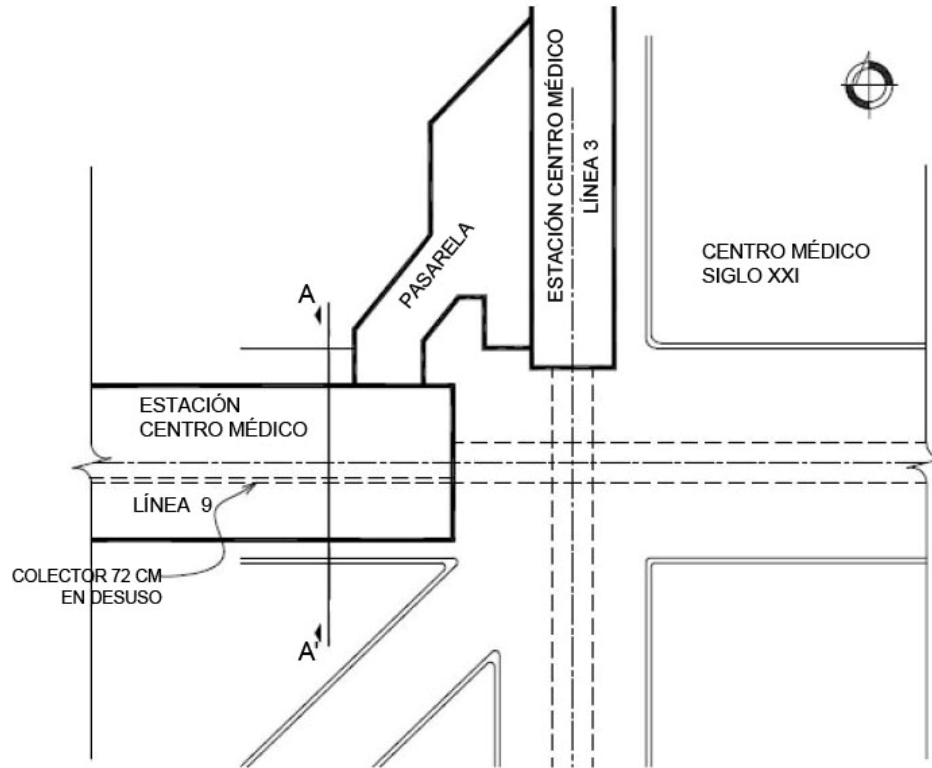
Vista en planta de las Estaciones Centro Médico L-9 y L-3.
